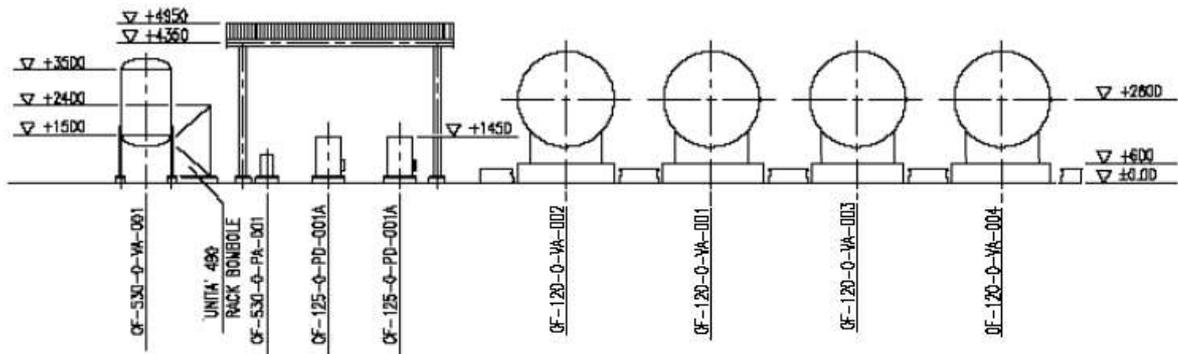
Impianto pilota di iniezione CO<sub>2</sub> e apparecchiature (sezione)
